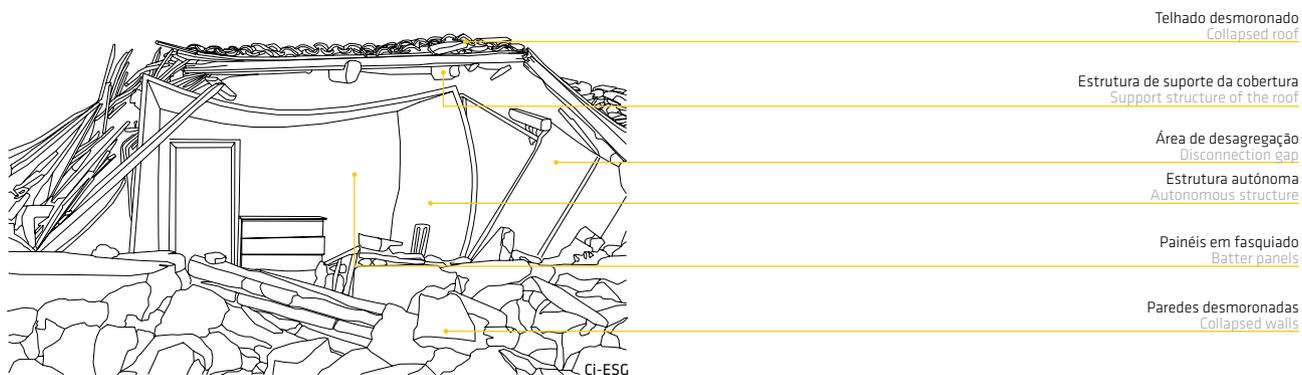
Estrutura interna de madeira, Faial / Internal wooden structure, Faial
